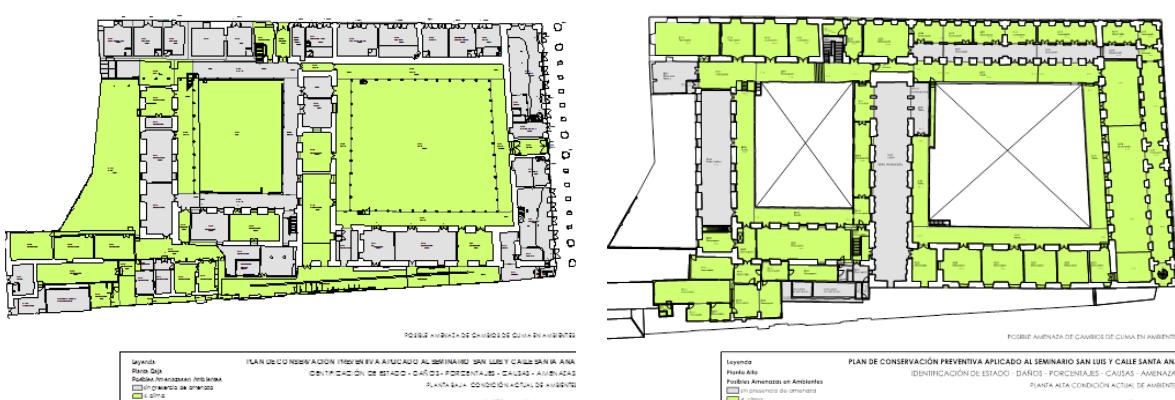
; Imagen 4-14: SIG (ArcGIS), Planta Baja y Planta Alta con amenazas del clima.
